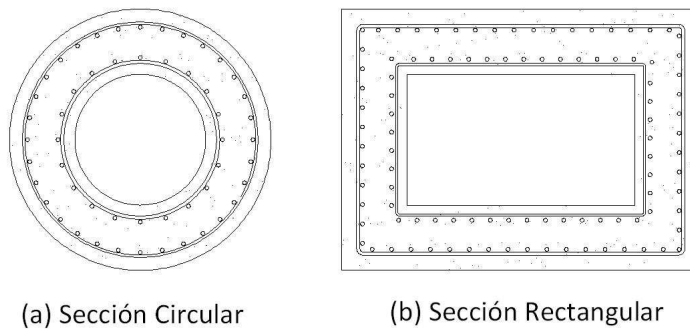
Secciones Típicas Huecas para Columnas de Subestructuras
